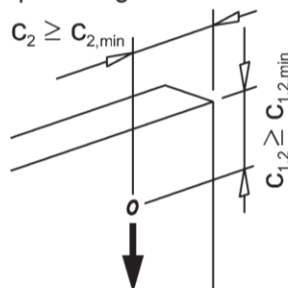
Einbauzustand Querbeanspruchung ohne Betonkantenbruch, ohne Rückhängebewehrung
